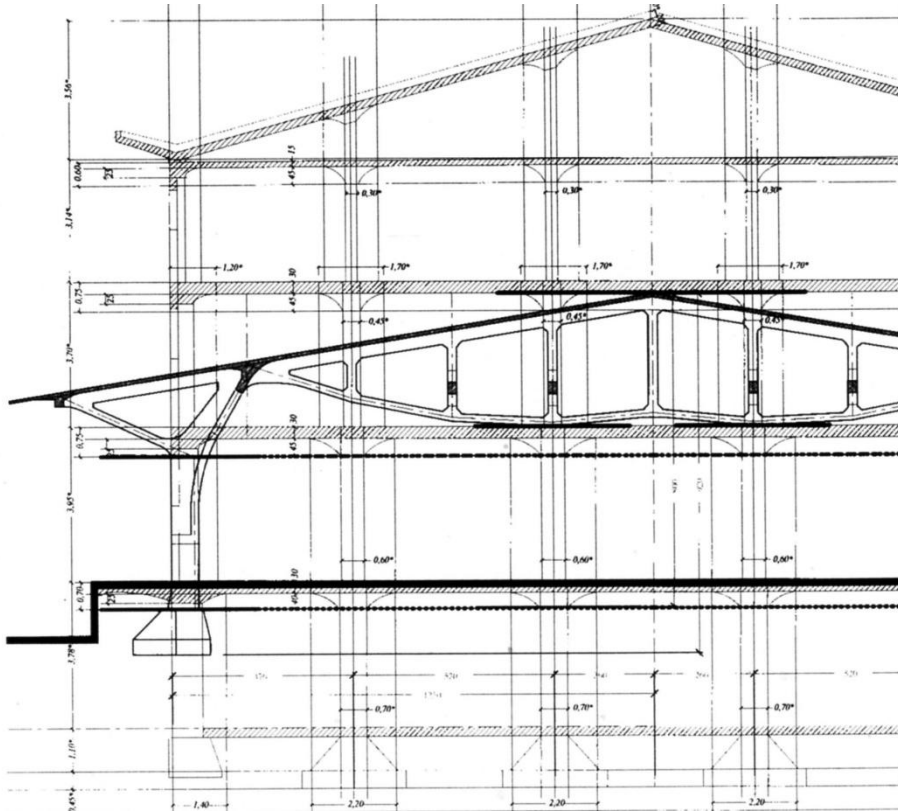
Superposición de de las líneas estructurales del edificio principal de los Almacenes (en segundo plano) y de los pórticos exteriores. Sistema constructivo de losa de hormigón de espesor constante y capiteles fungiformes. (Zastavni, 2008b: 248) (Fot. Ticin)
